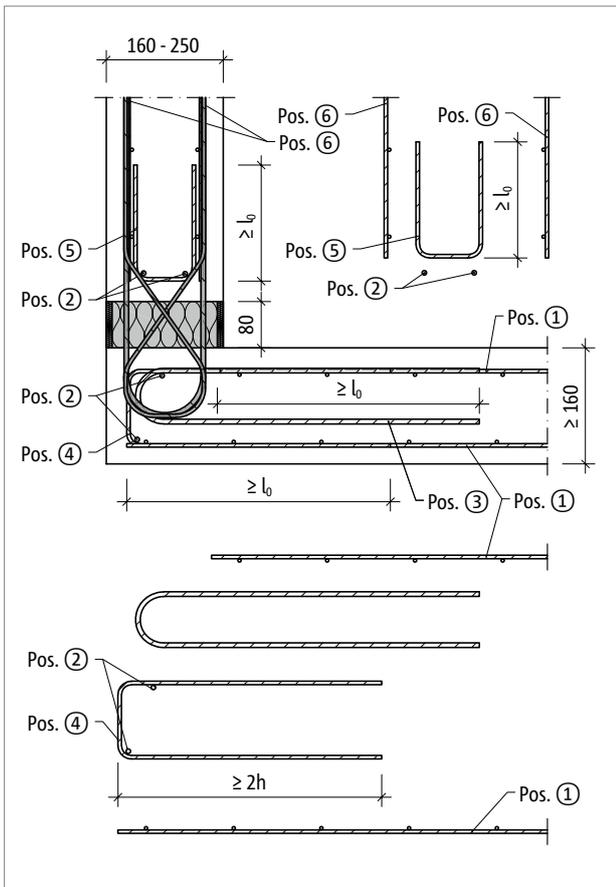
Schöck Isokorb® T Typ AP vertikale Anordnung: Bauseitige Bewehrung
